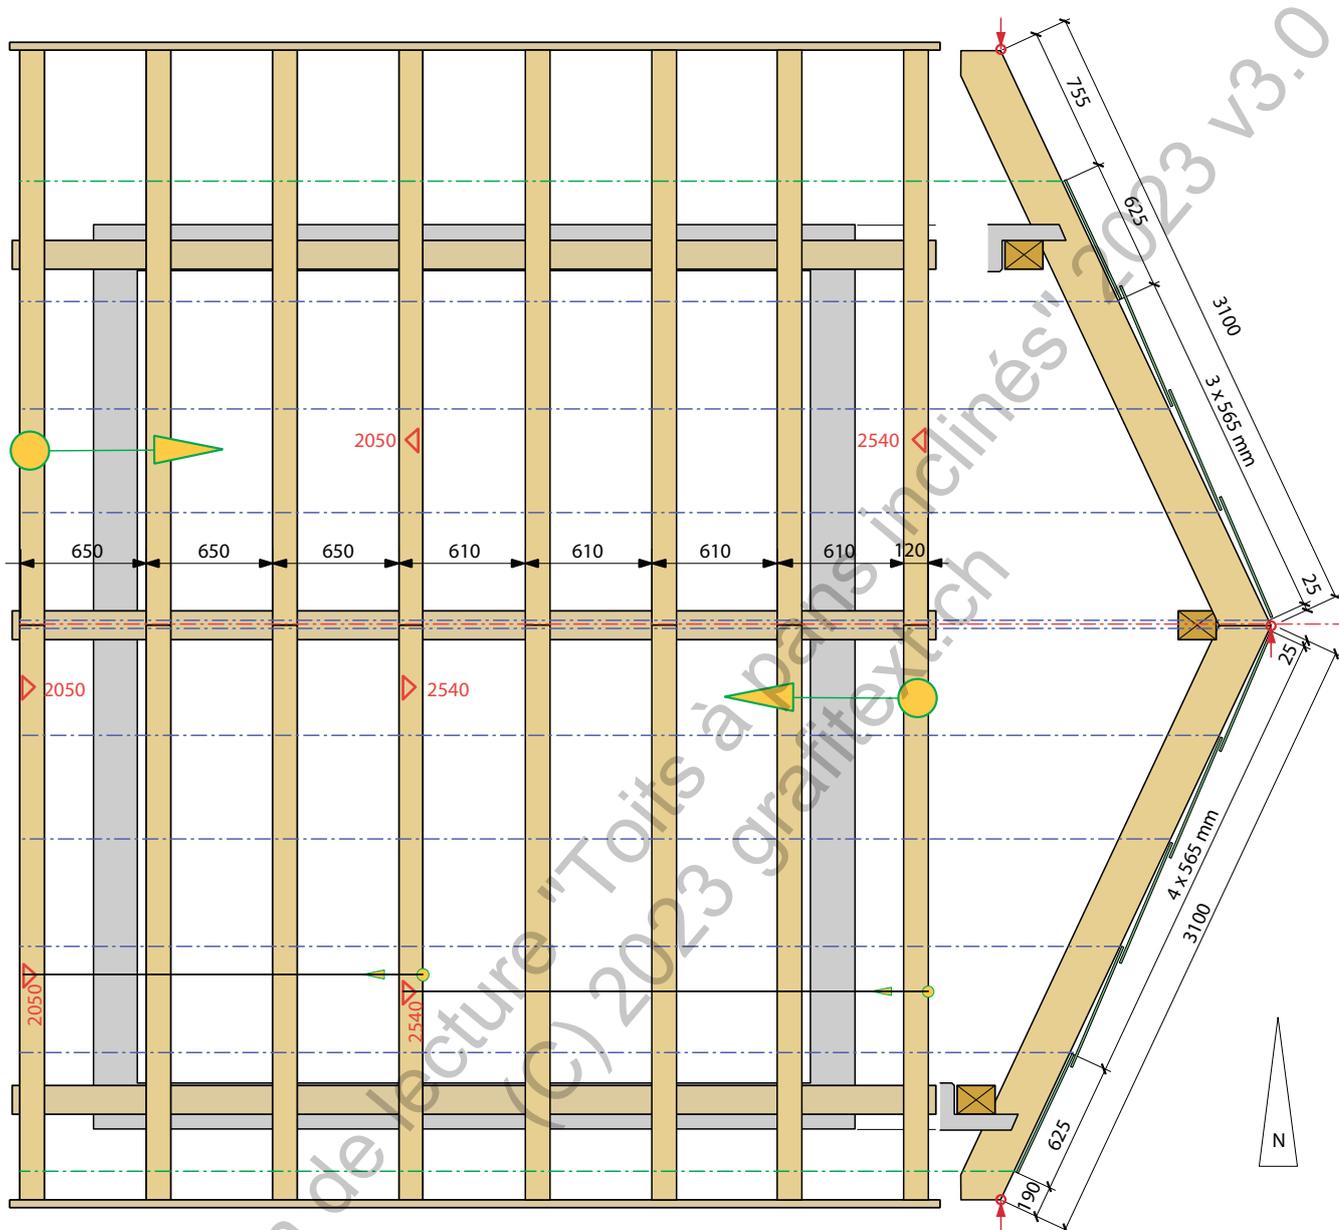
/229: Plan de montage des plaques de sous-couverture en fibres-ciment, objet XY
